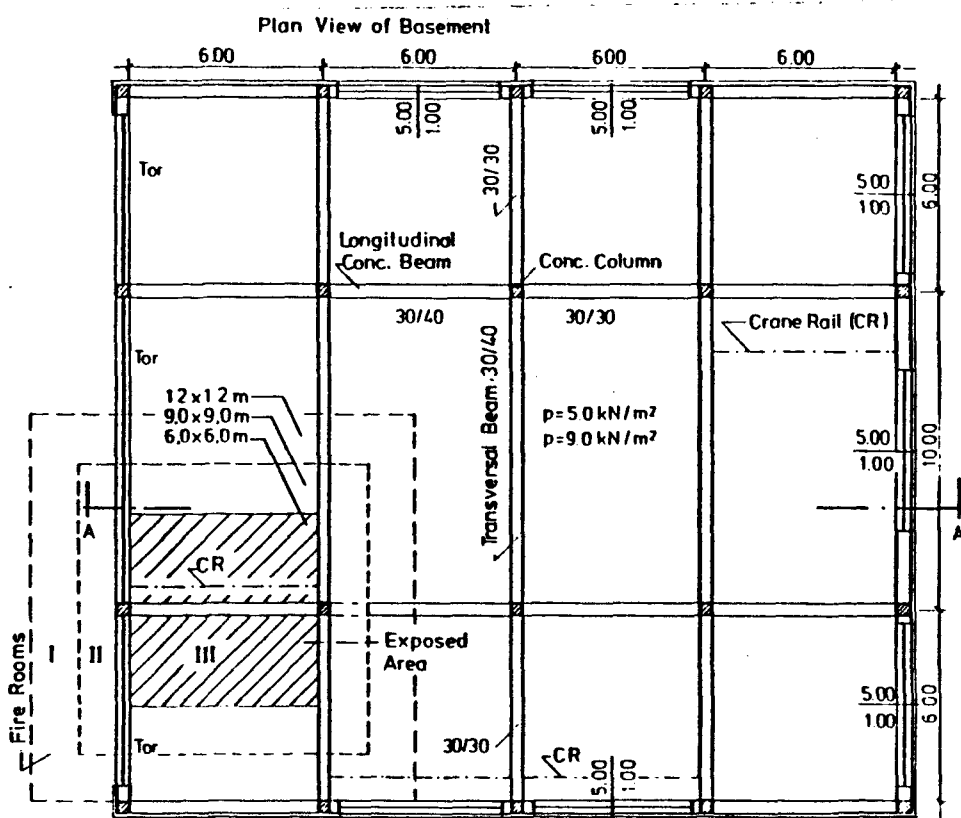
Kellergeschoss der untersuchten Stahlbetonkonstruktion
